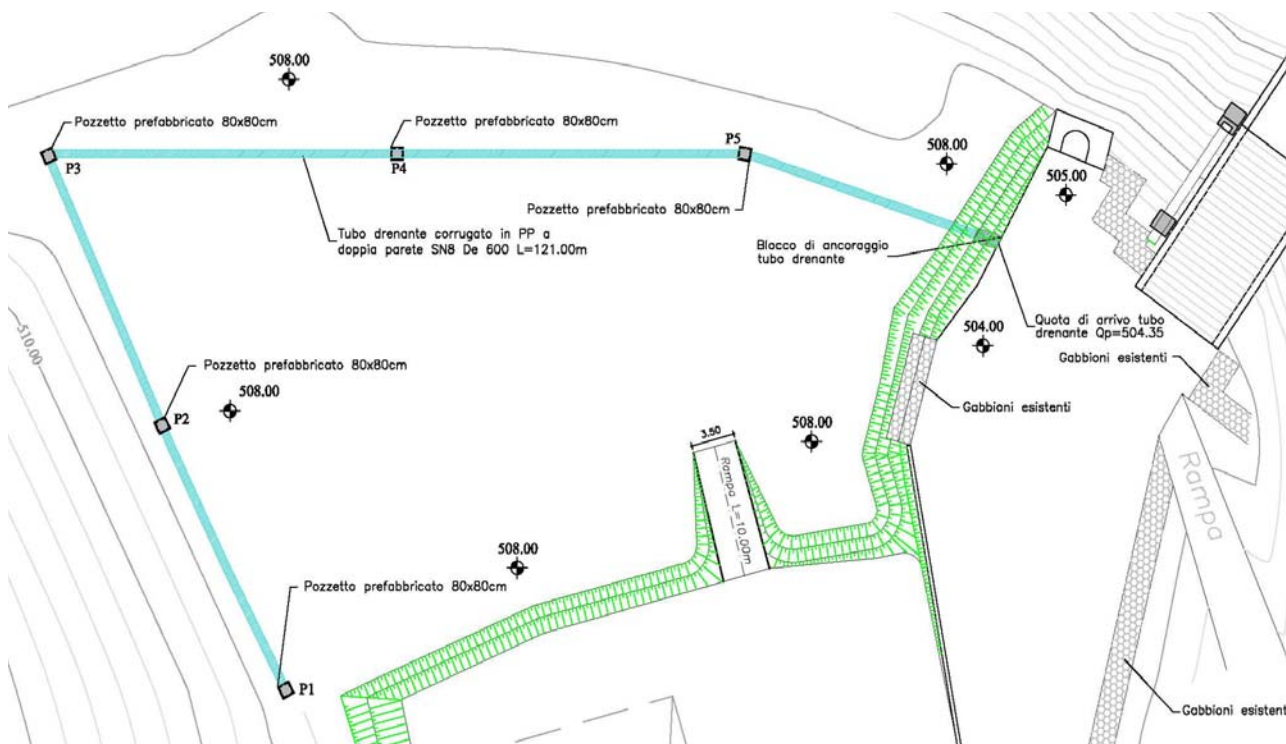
Planimetria drenaggio a valle dello sbarramento
